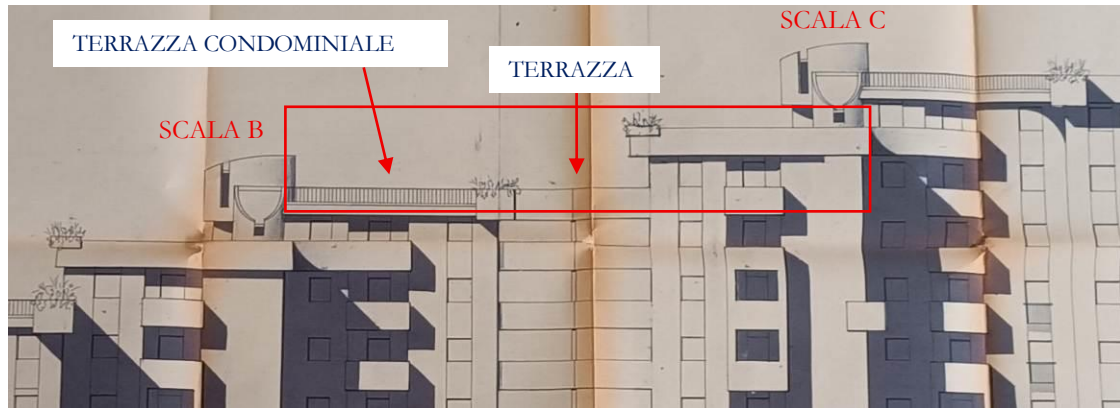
Planimetria di rilievo attuale con indicazione delle difformità riscontrate.
